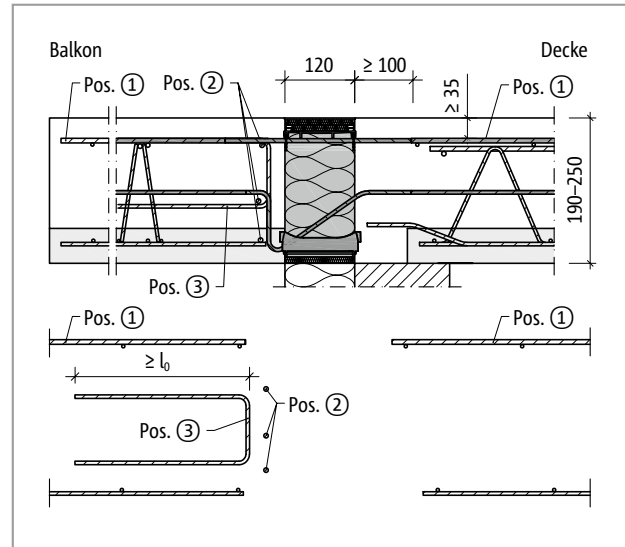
Schöck Isokorb® XT Typ K-F: Bauseitige Bewehrung bei Balkonplattendicke  $h = 190\text{--}250\text{ mm}$
